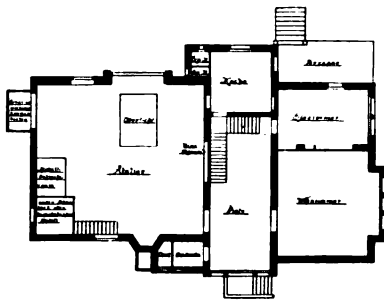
Villa Waldfrieden. Erdgeschoss.
